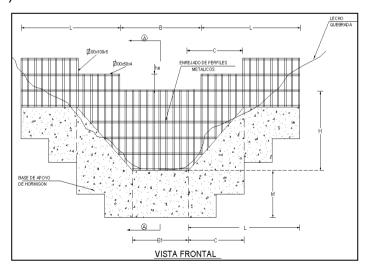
Muro con Enrejado Metálico Tipo Peineta de Viguetas Prefabricadas Fuente: J. Lema
